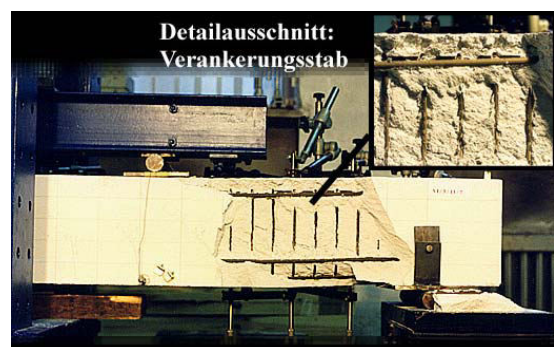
Untersuchungen zur Querkrafttragfähigkeit bewehrter Elemente aus Porenbeton
